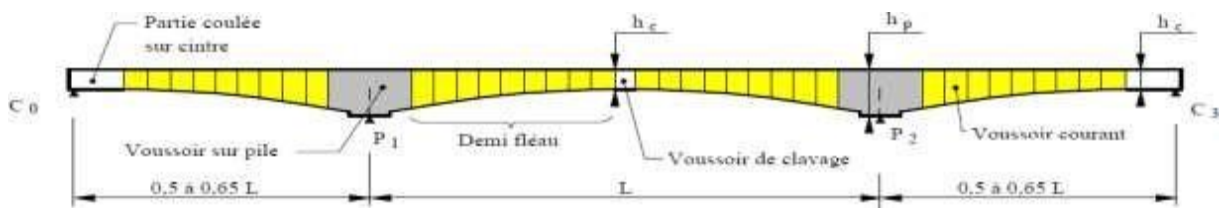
Coupe longitudinale du pont construit par encorbellement de fléaux successifs
